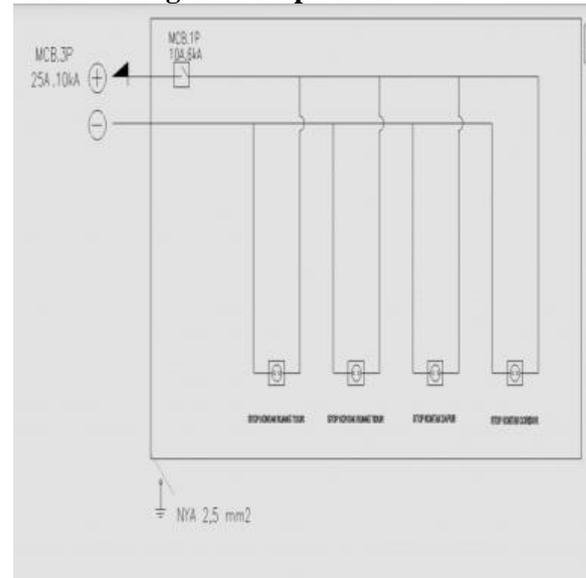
Rangkaian instalasi lampu lantai 2
